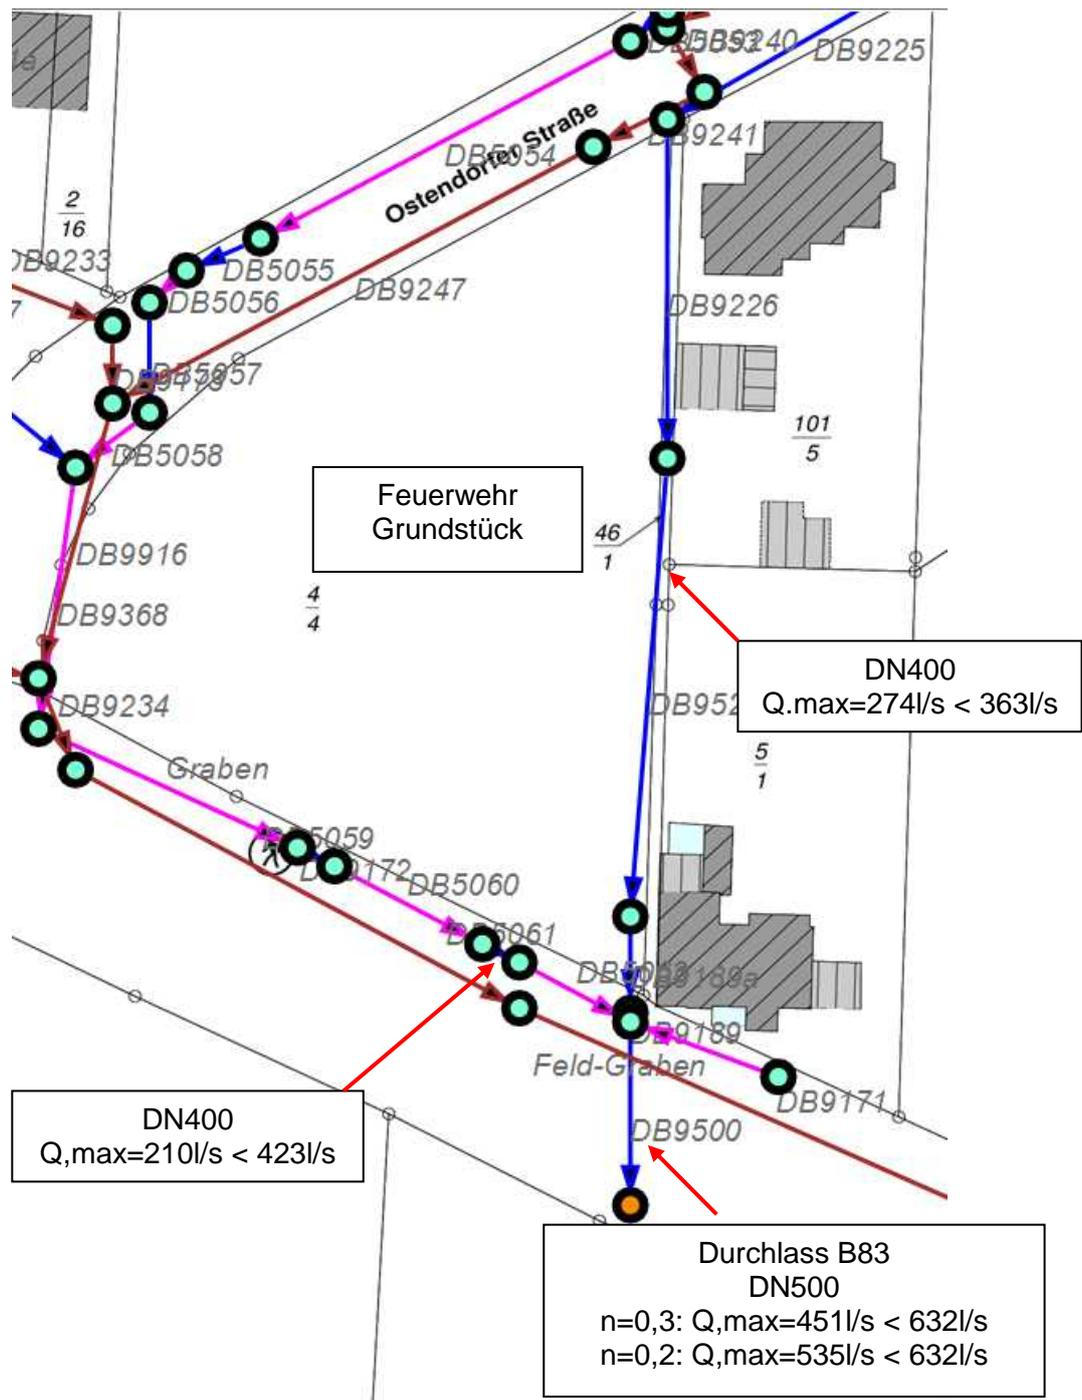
Ergebnis im Lageplan, Belastung mit 3-jährlich auftretendem Niederschlag
